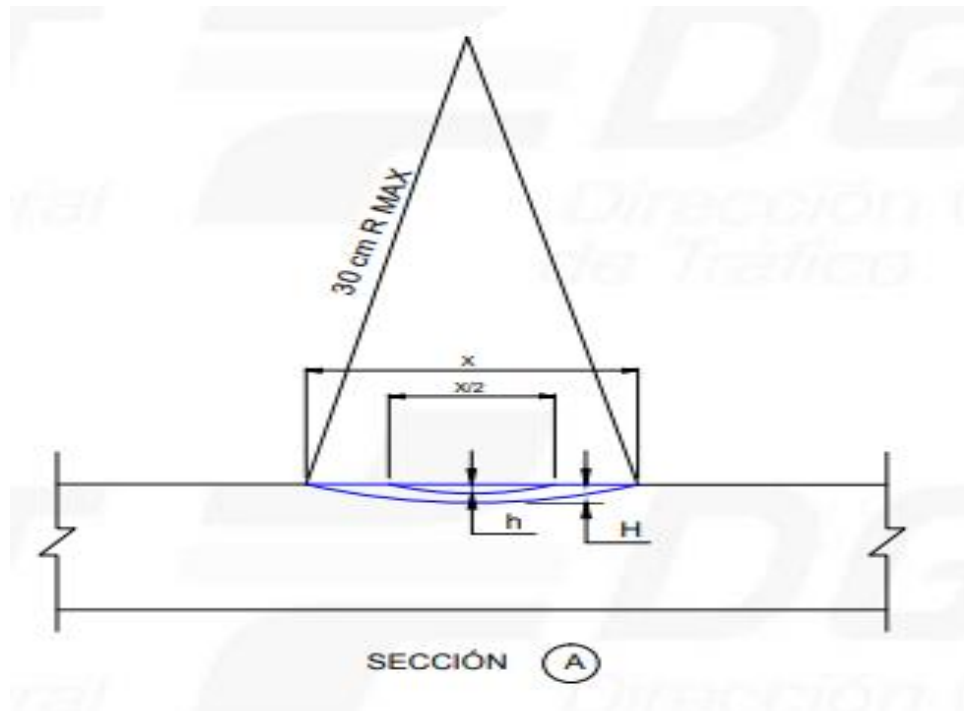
DGT (2018). Sección longitudinal de guía sonora longitudinal trapezoidal.
